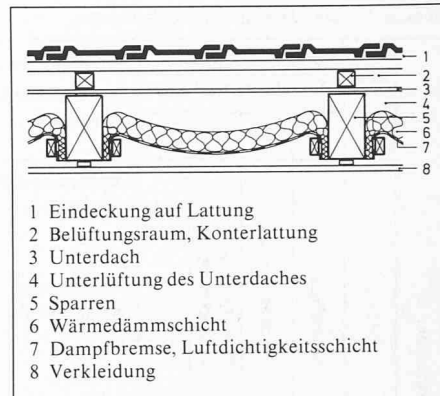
Traditionelle, konventionell zwischen den Sparren wärmedämmte Steildachkonstruktion (Querschnitt)
